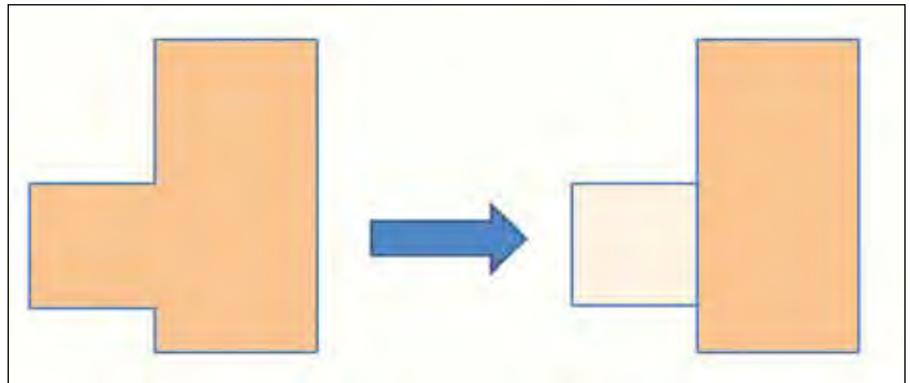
Trennung eines Gebäudegrundrisses in zwei Bauteile
